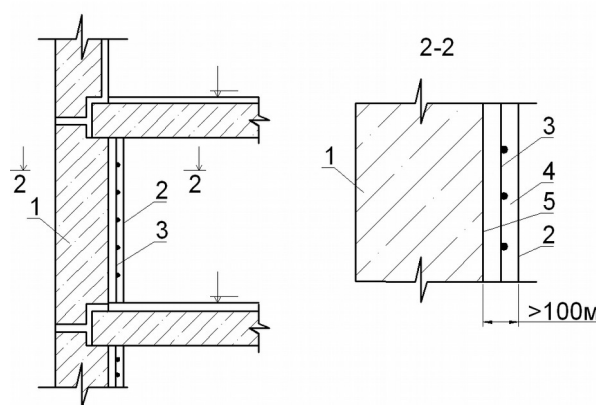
Улаштування монолітної залізобетонної стінки із внутрішнього боку:
